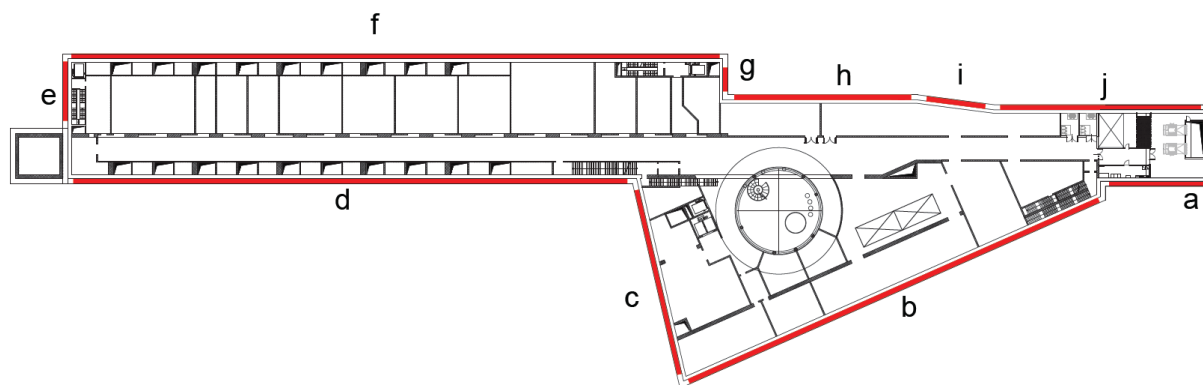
Planimetria del piano banchina del Deposito-officina Rebaudengo con indicazione dei diaframmi termicamente attivabili.
